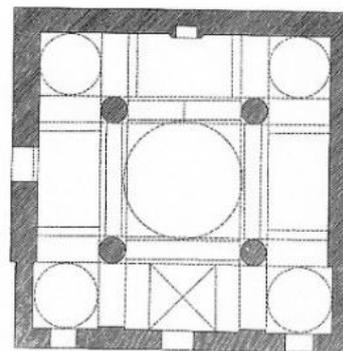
مسقط أفقي لجامع السلطان أحمد بإستانبول ومخططه من قبة تتعامد على محاورها الأربعة انصاف قباب ويتقدمهم صحن ضمن مجمعه
